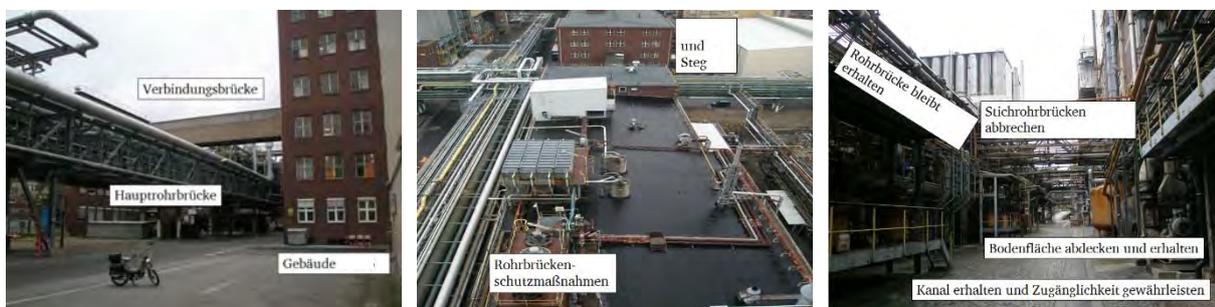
Übergang zum Gebäude Blickrichtung Osten, Dachansicht und Hauptrohrbrücke Blickrichtung Süden und Stichrohrbrücke Blickrichtung Norden (v.l.n.r.)
